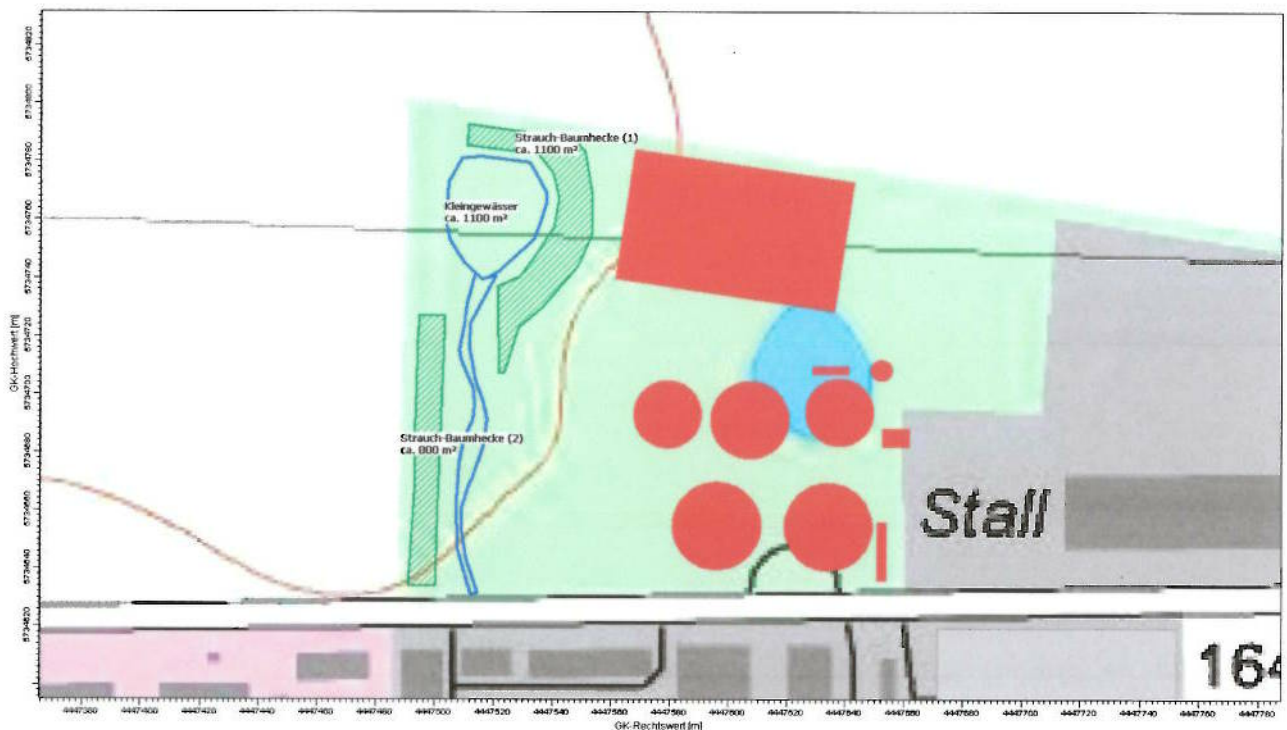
Lage neuangelegtes Kleingewässer einschließlich Bepflanzung
